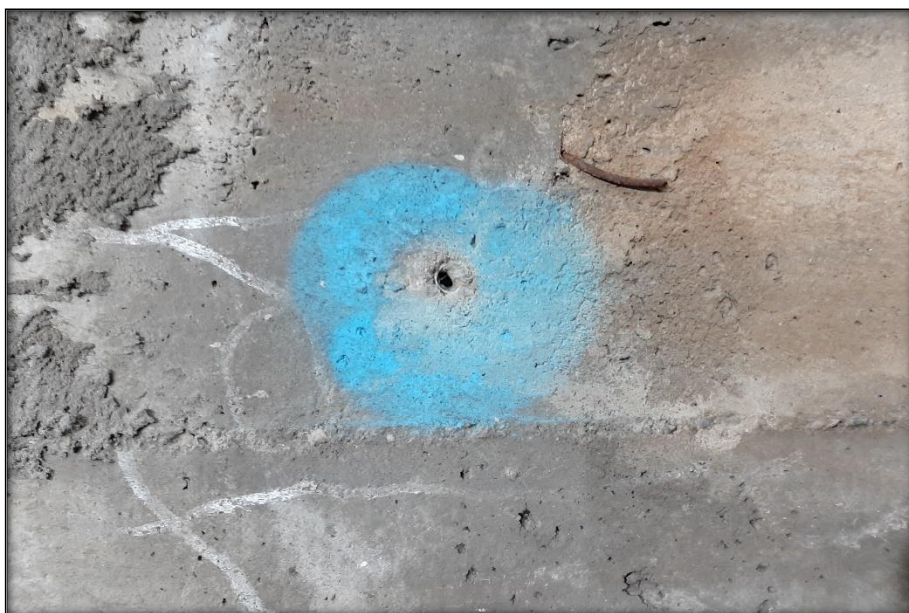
Muro de concreto armado con presencia de escantillones de madera, generando grietas
